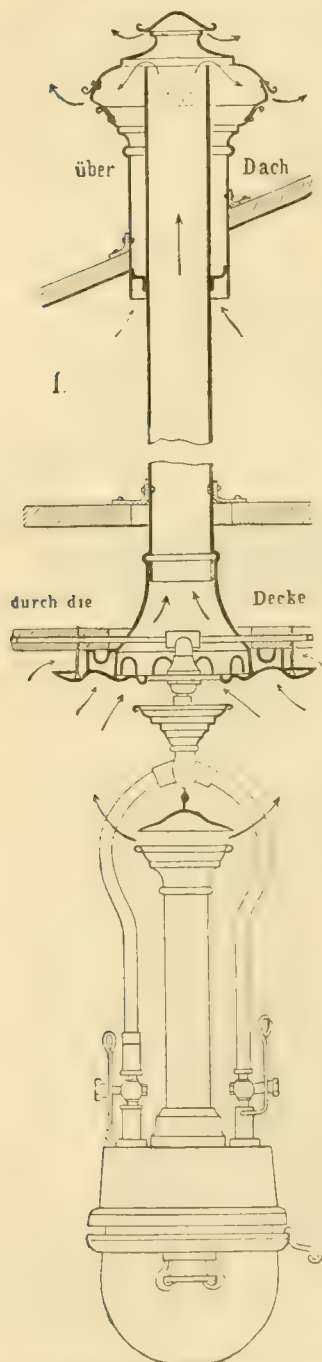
Westphallampe mit Ventilationsvorrichtung
